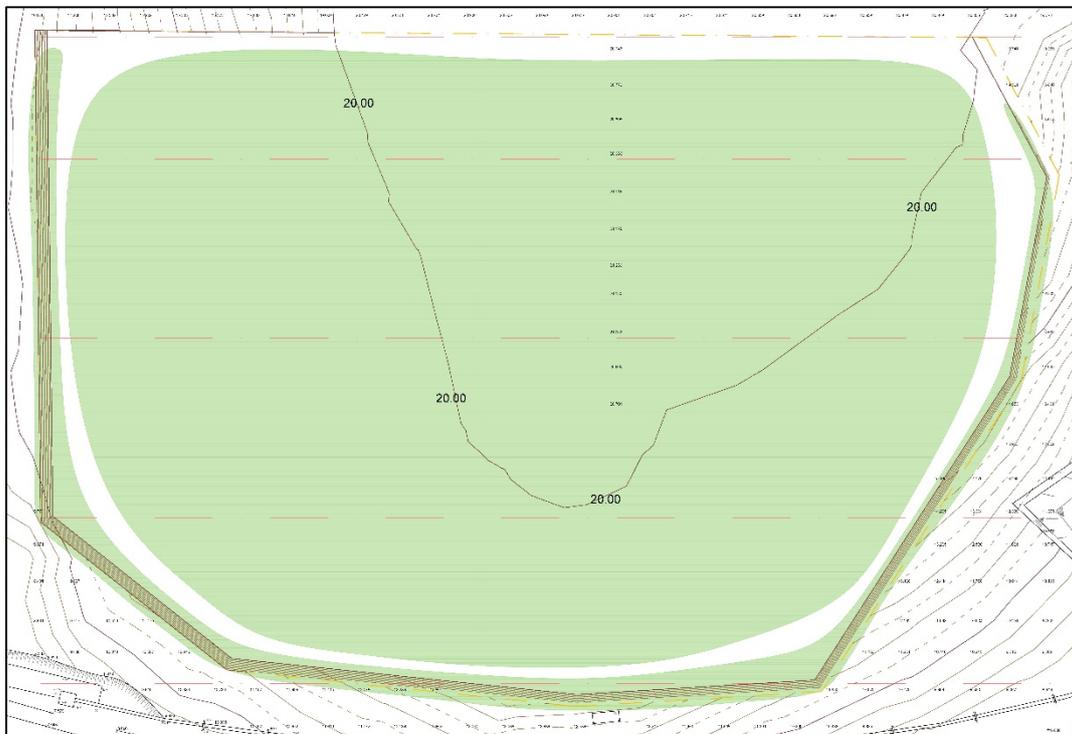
Planimetria Area Interna – Stralcio Tav. TR-ONS-E-P-DW-026-R03
